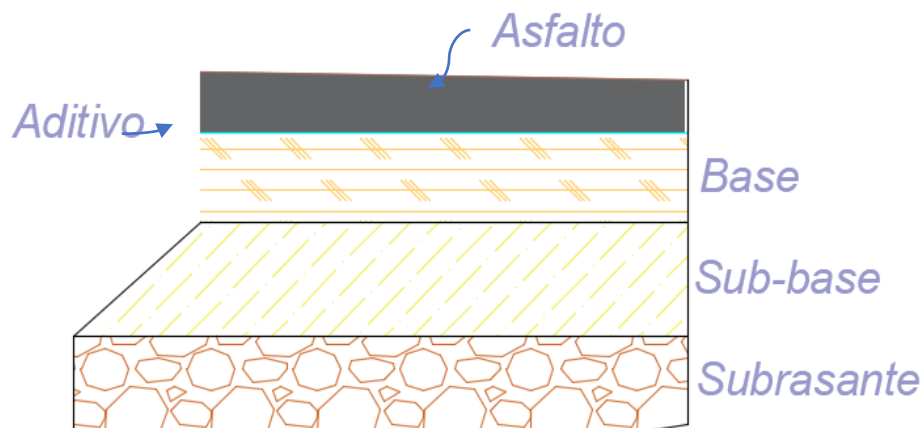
esquema del paquete estructural del pavimento semi rígido.
